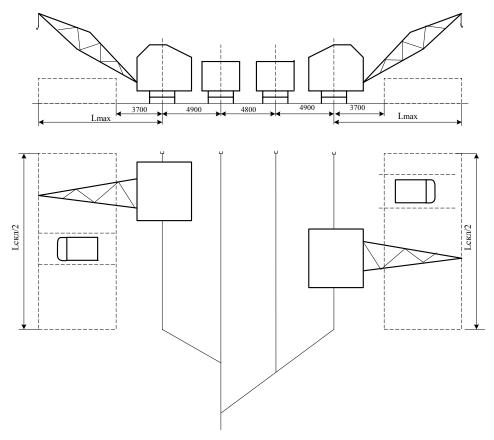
Поперечный разрез и план двухпролетного склада со стреловыми железнодорожными кранами
